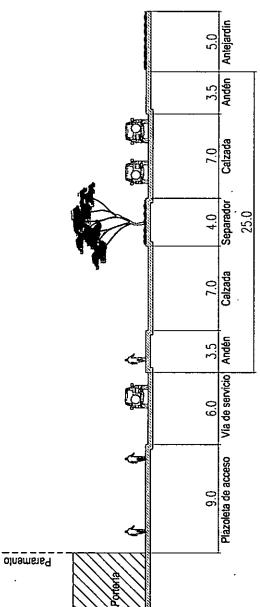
Sección vial Carrera 87 entre Calle 30 y Calle 31. Fuente: Equipo técnico Plan Maestro API_39 Universidad de Medellín.
